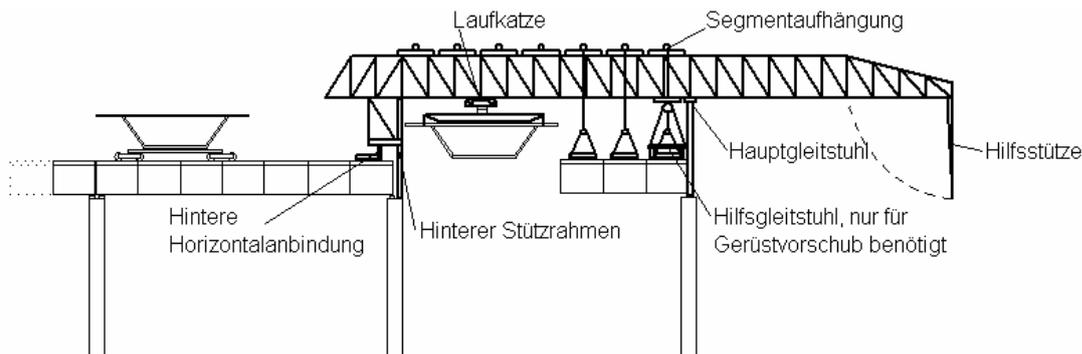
Segmente mit oben liegendem Verlegegerüst [18], [19]
